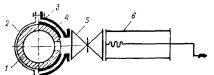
Схема устройства для присоединения ввода: 1 – труба наружного водопровода; 2 – хомут; 3 – седелка;
